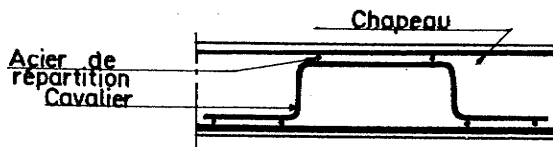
Cavalier support permettant la fixation des barres de répartition et des chapeaux.
